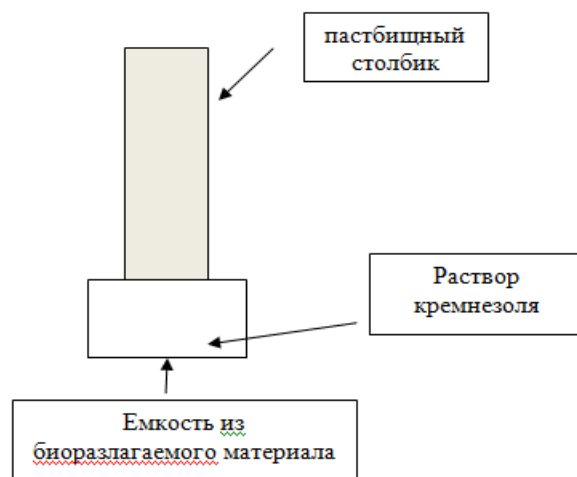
Схема упрочнения изделия из бетона методом капиллярного подсоса кремнезолом при установке сваи или пастбищного столбика
